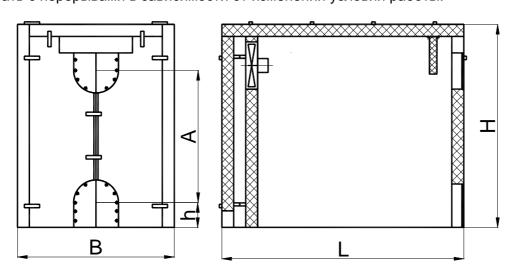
Звукоизоляционный кожух приспособленный для всасывания воздуха из трубопровода.
